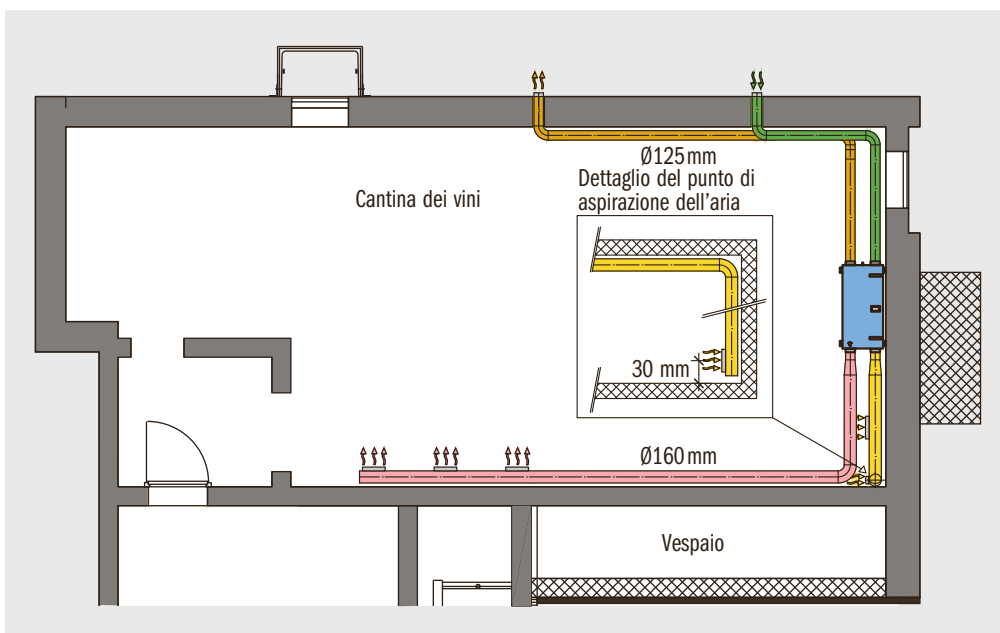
Schema dell'impianto di ventilazione meccanica.
